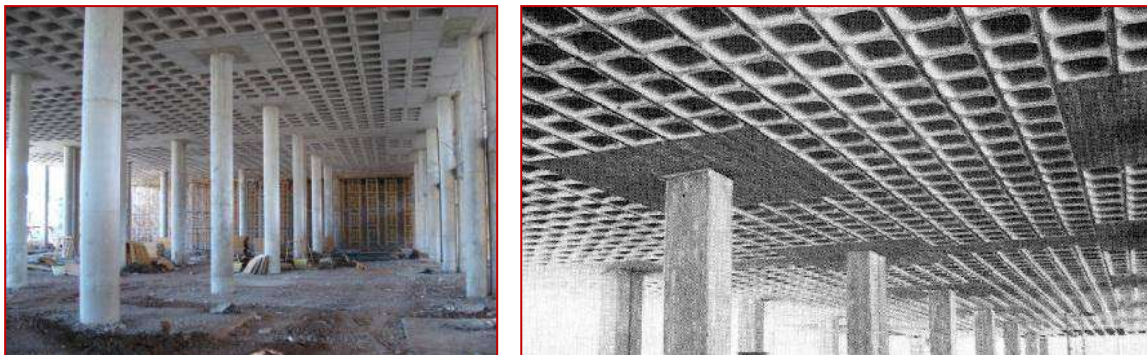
, 67. Losa reticular en obra donde se aprecia el capitel que transmite las cargas a la columna. Fuente. [www.construmatica.com](http://www.construmatica.com)
